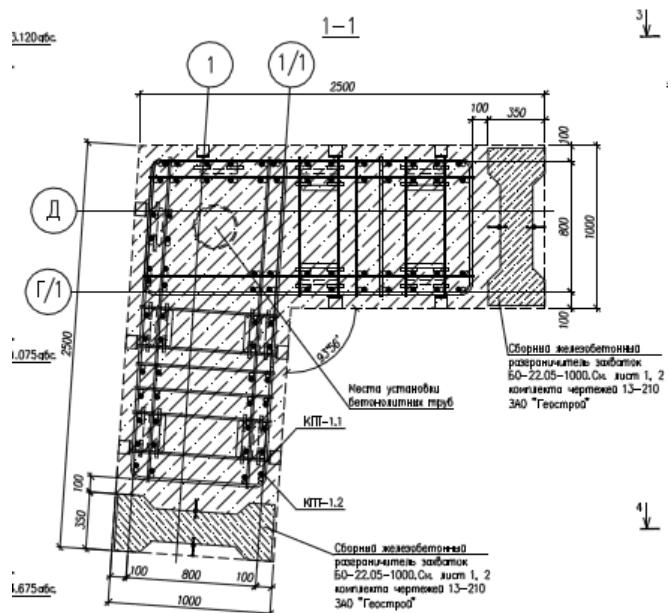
Схема монтажа арматурного каркаса и ограничителей в траншее
